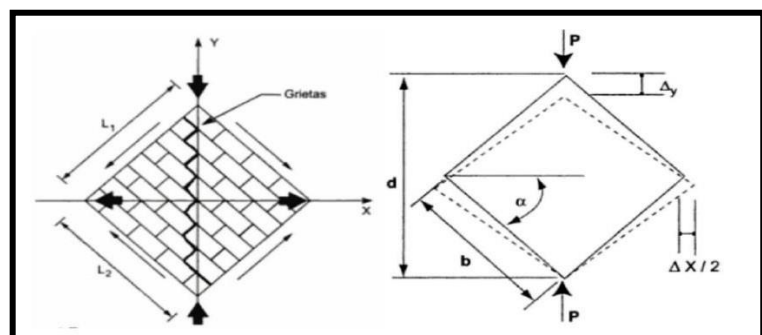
Esquema de deformación para ensayo de corte en muretes.
